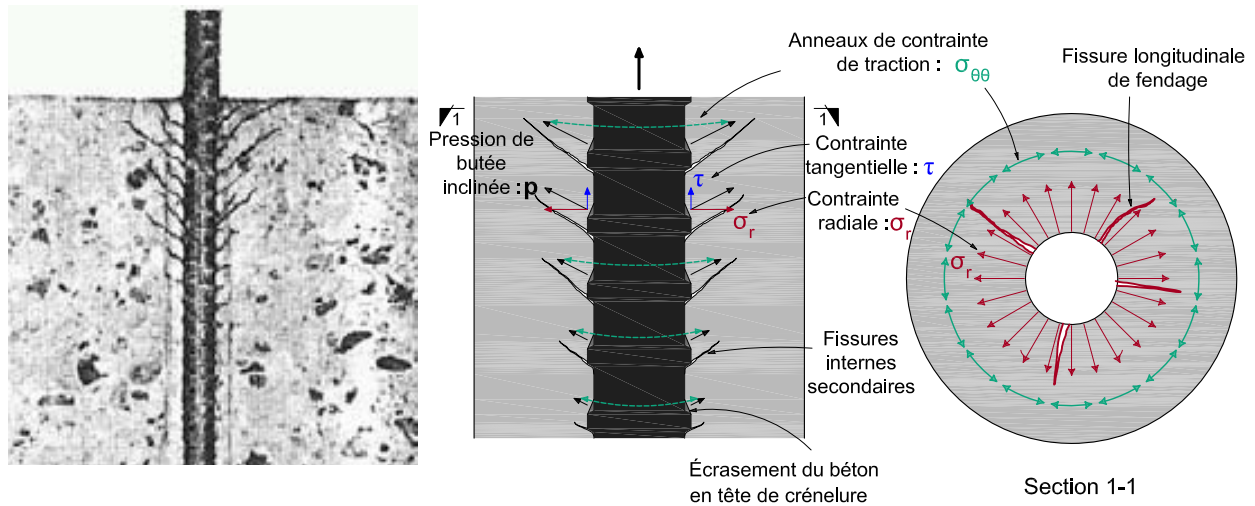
Mode de rupture par fendage du béton à la jonction pile-semelle
